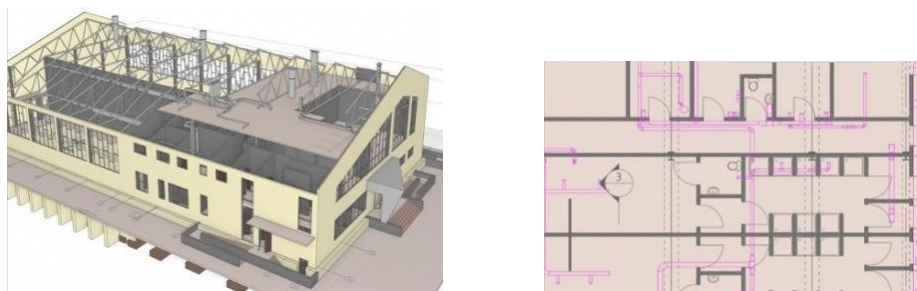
3D-модель будівлі. Креслення плану поверху
